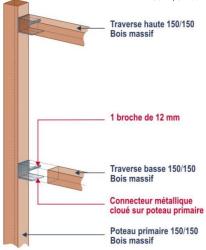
Assemblage des poutres primaires sur les poteaux Source : Construction à ossature bois Le restaurant administratif du CETE de Lyon bv. transports. gouv.qc
